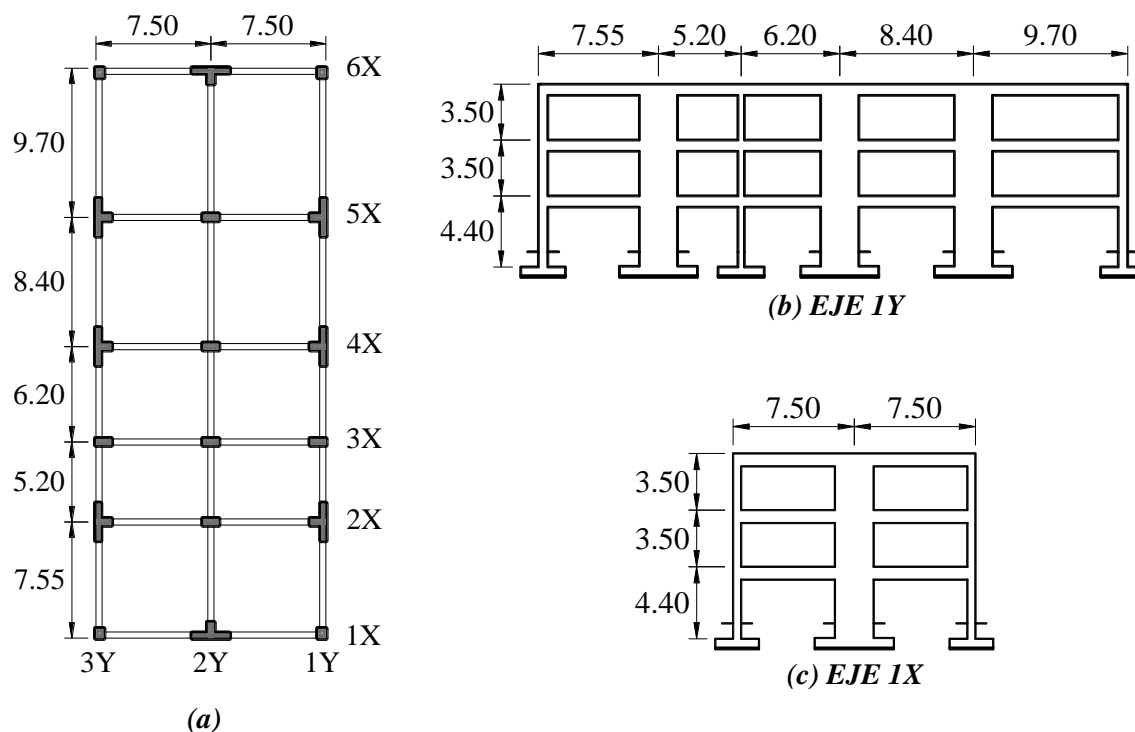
(a) Planta de la Oficina Central de Admisión. (b) Pórtico estructural longitudinal típico en el sentido Y-Y. (c) Pórtico estructural transversal típico en el sentido X-X.
